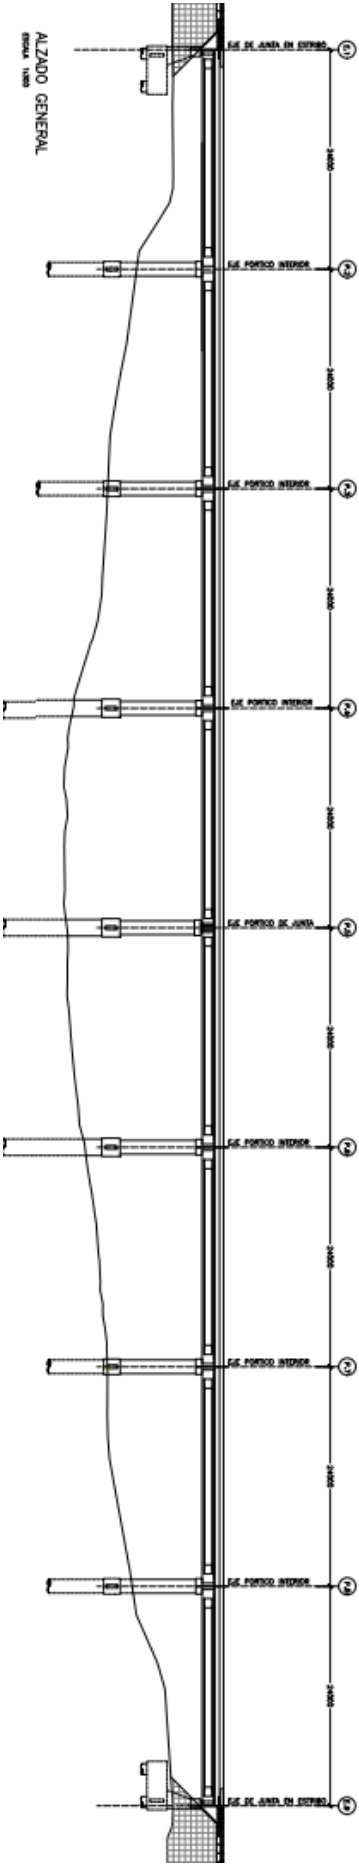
Puente sobre el río Cebollatí - corte longitudinal general
